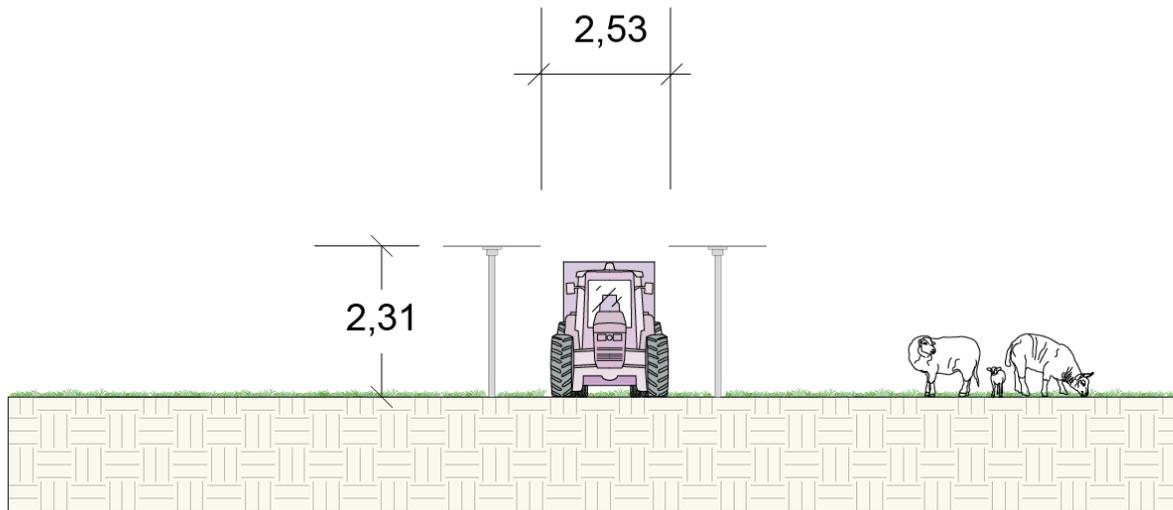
SISTEMA AGRIVOLTAICO ELEVATO, SEZIONE TIPOLOGICA DELL'IMPIANTO
